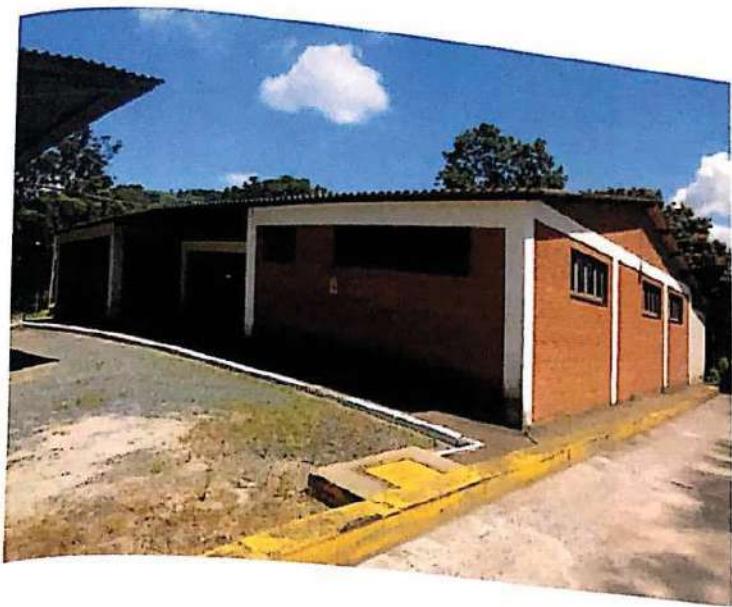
Escritório/Administração – Data aprox. da Construção-1988. Alvenaria em Tijolos de Barro, Laje, Cobertura em Estrutura Metálica com Telhas de Fibrocimento – AT = 286,32m².
